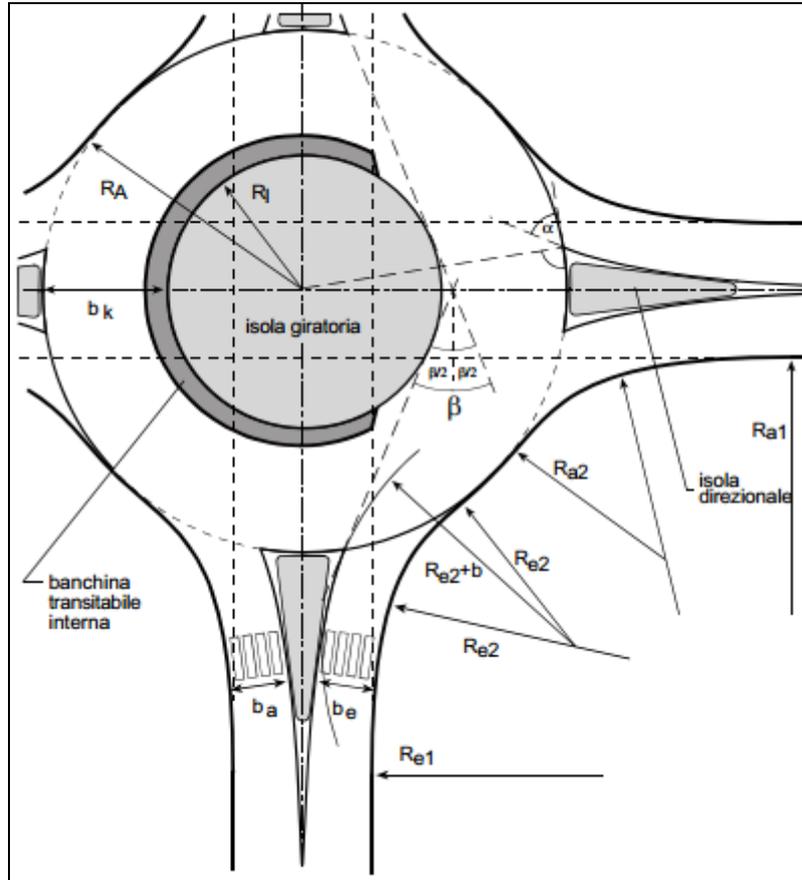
SCHEMA PLANIMETRICO DELLA ROTATORIA
